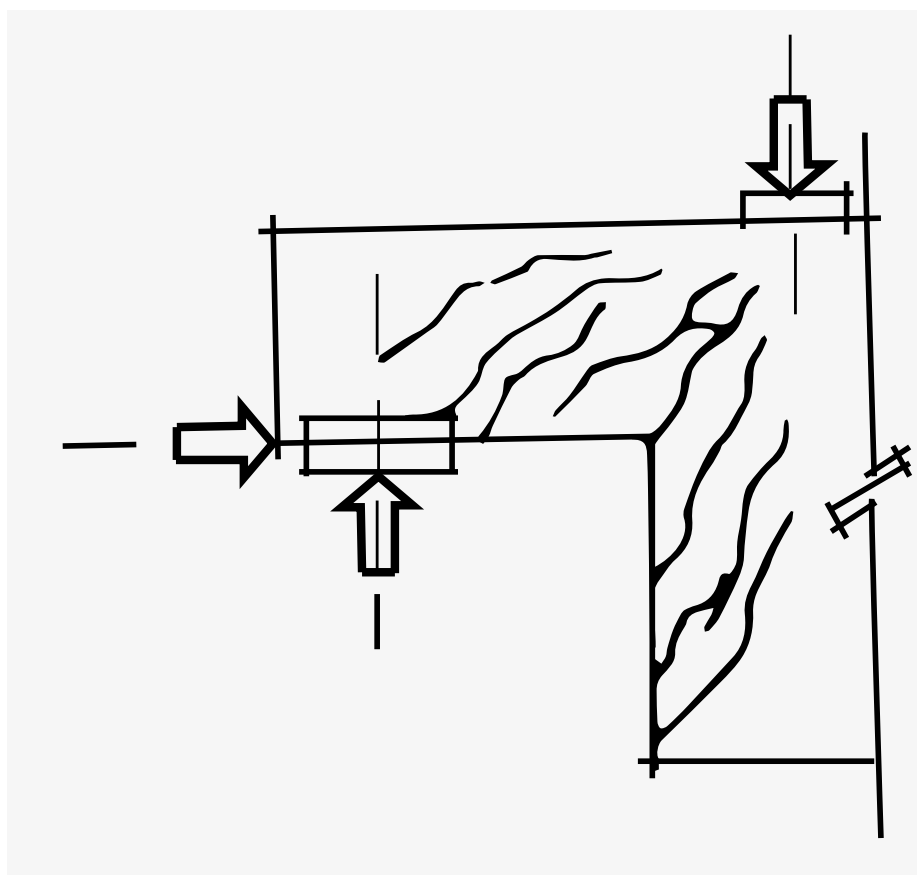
Patrón típico de agrietamiento en apoyo.¹¹
